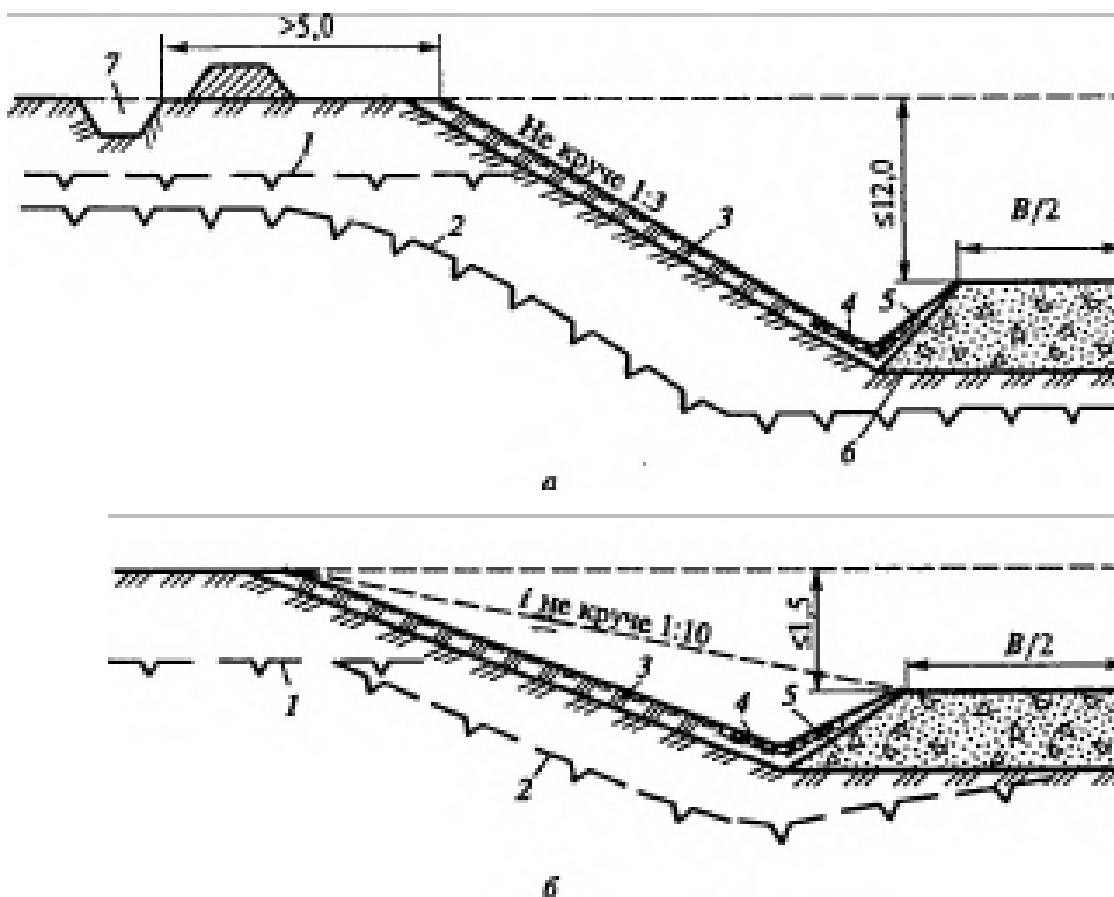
Поперечные профили выемок в слабольдонасыщенных грунтах
